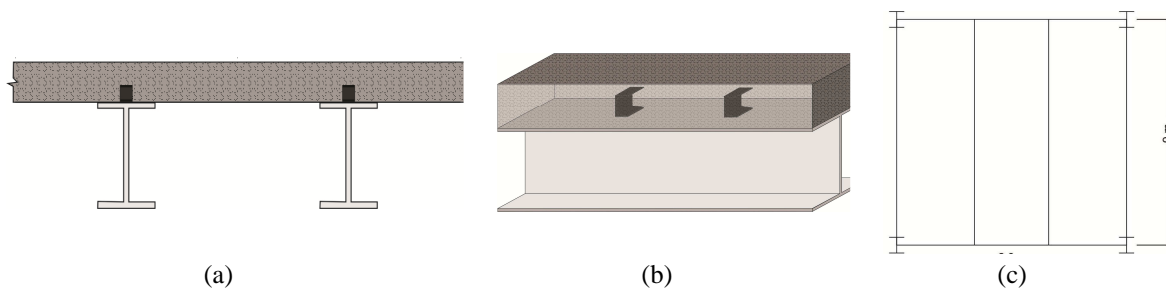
Viga mista do estudo de caso 3: (a) Vista frontal; (b) Vista lateral; e (c) Vista superior.
